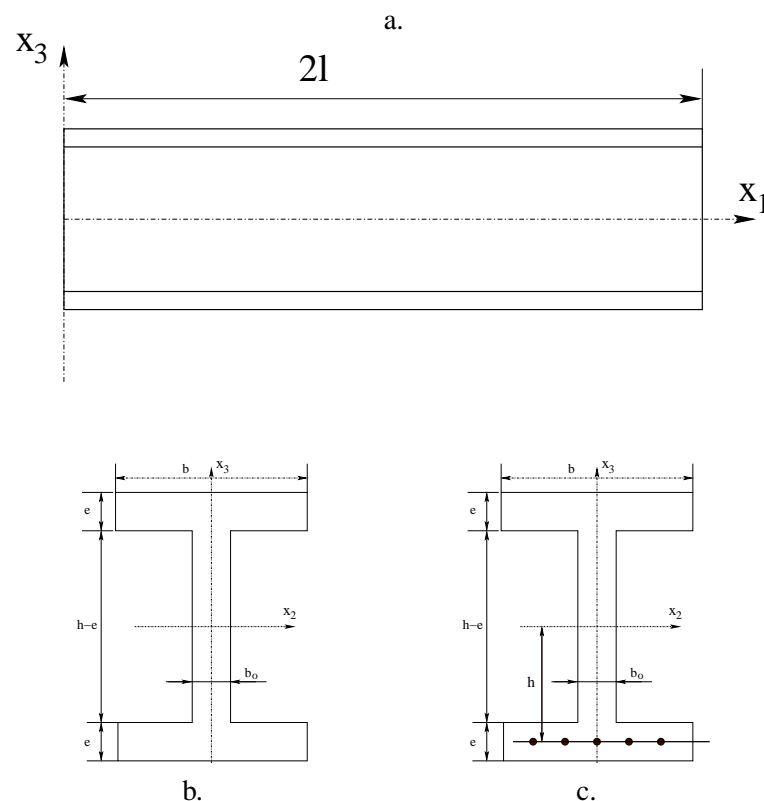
Vue de la poutre, (a) de profil, (b) en section. (c) Poutre renforcée.
